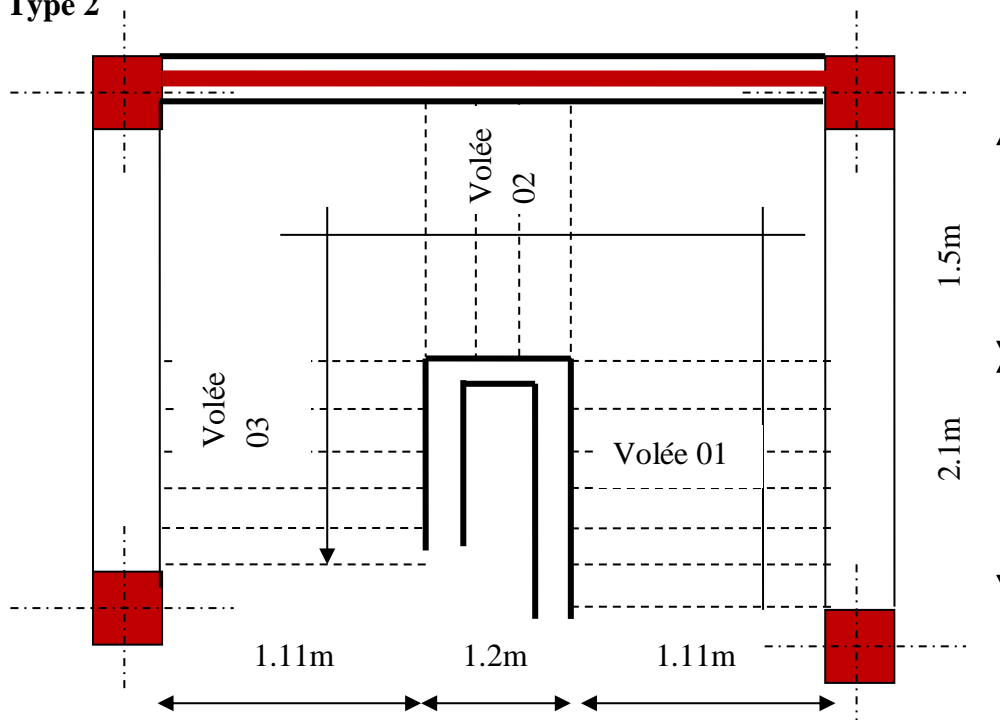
Vu en plan de l'escalier (type) 02)
